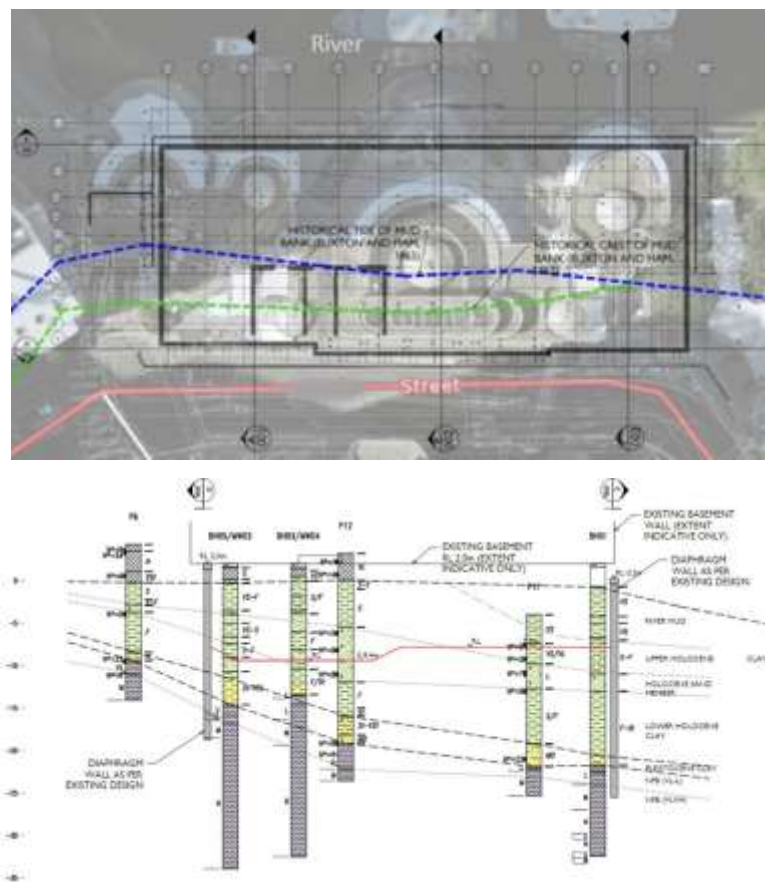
Planta e Seção Transversal extraídas de MGG para um edifício com subsolo em uma área ribeirinha. A linha vermelha indica o novo nível do subsolo.
